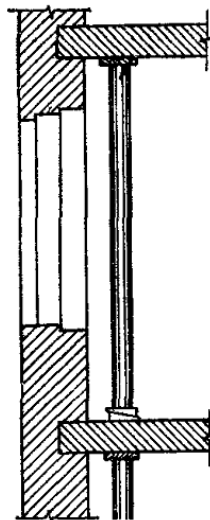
Вывешивание балок перекрытия, опирающихся на перекладываемый простенок
